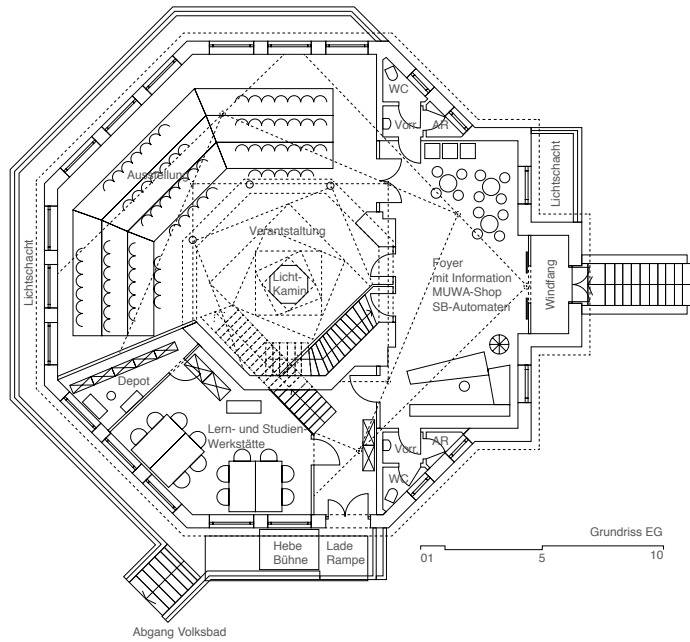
M. Kocher, 1992: Grundriss EG
